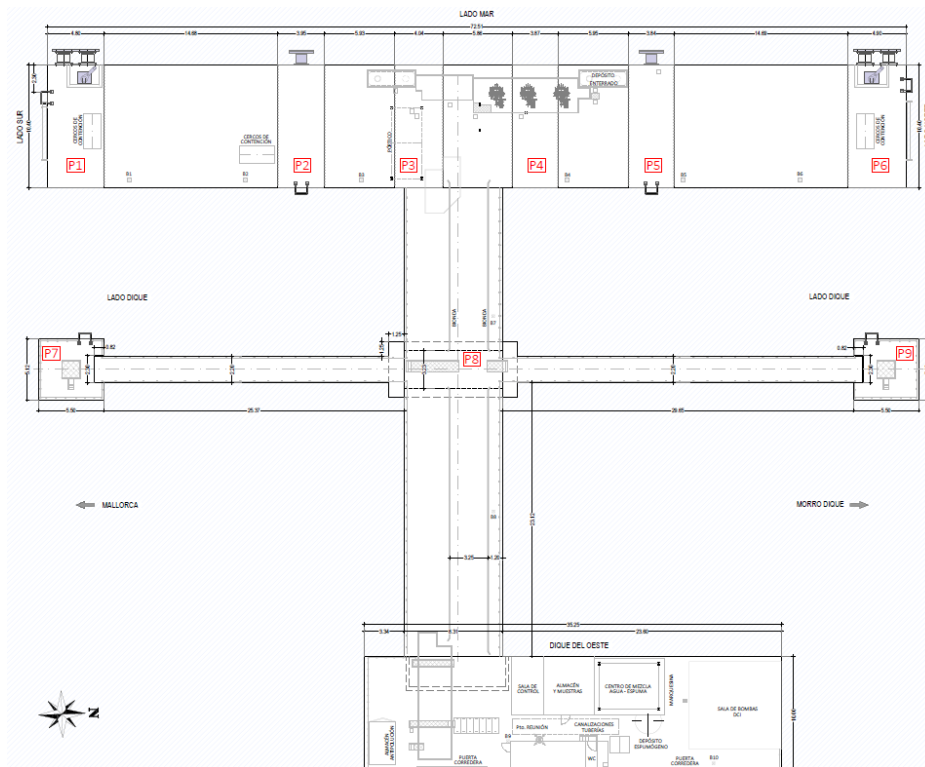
Planta aproximada y codificación de las pilas-cajón del Terminal
